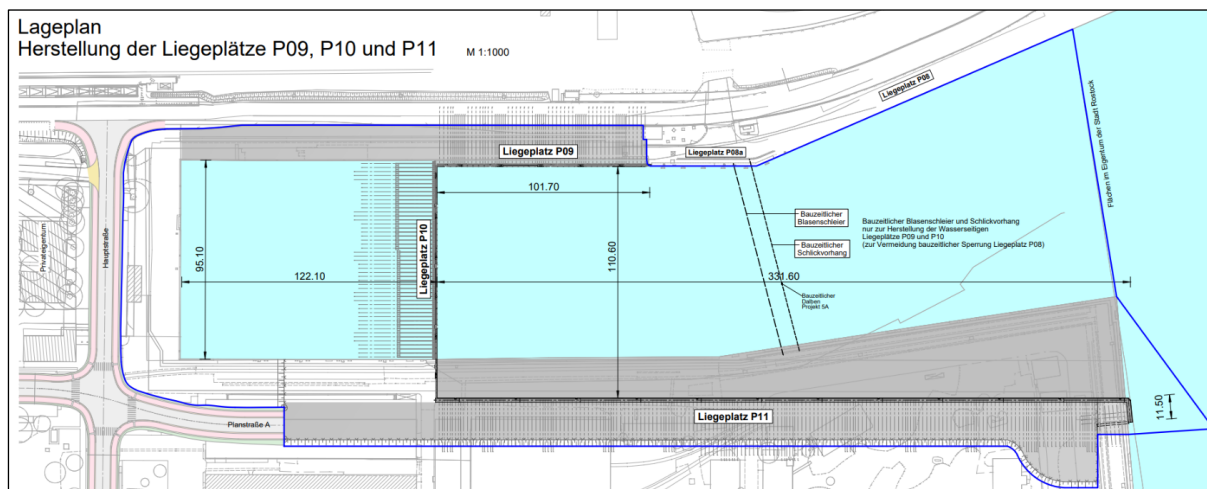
Lageplan Projekt 4: Herstellung der Liegeplätze P 09, P10 und P 11
